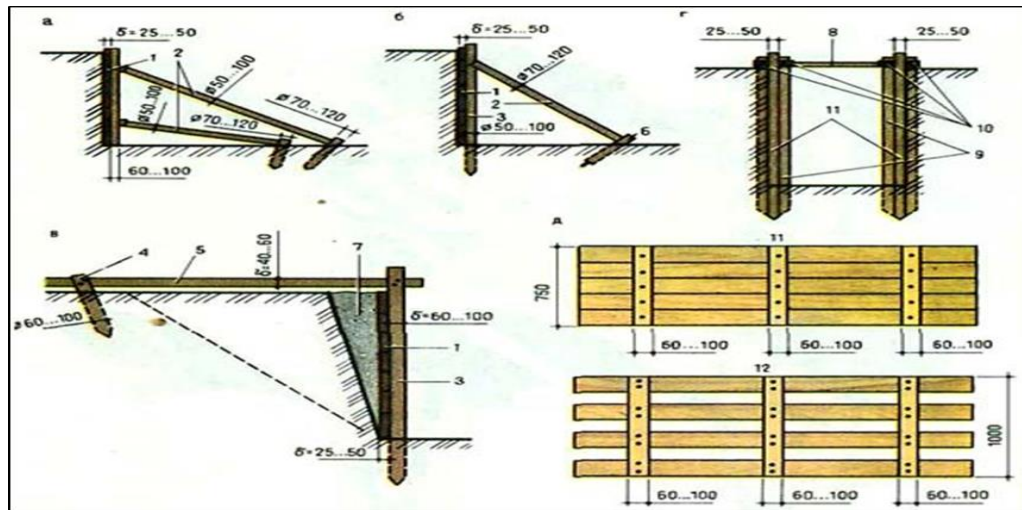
Кріплення стінок траншеї або котловану: підкісне (а, б), анкерне (в) і шпунтове (г) кріплення зі щитами з дощок (д): 1 - щит кріплення; 2 - підкоси; 3 - стійка; 4 - анкер; 5 - тяга; 6 - паля; 7 - засипка; 8 - розпірка; 9 - стійки шпунтового огорожі; 10 - поздовжні бруски; 11 - дошки шпунта.
